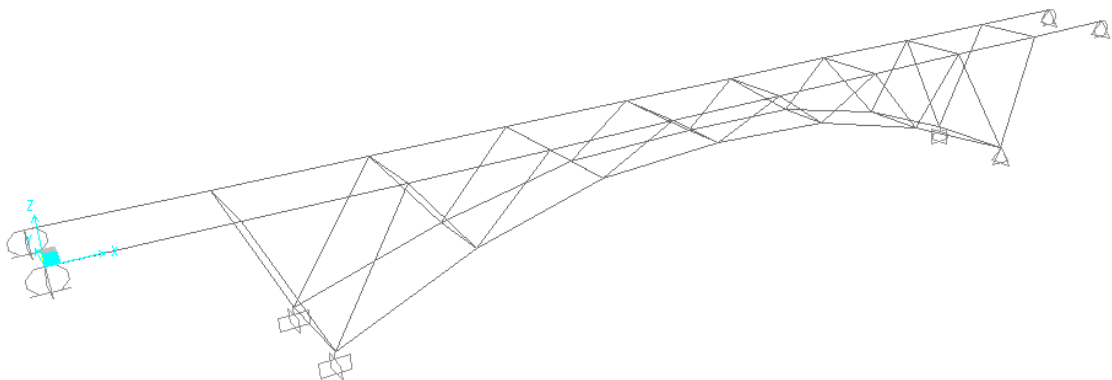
Configuração da estrutura metálica em SAP2000
